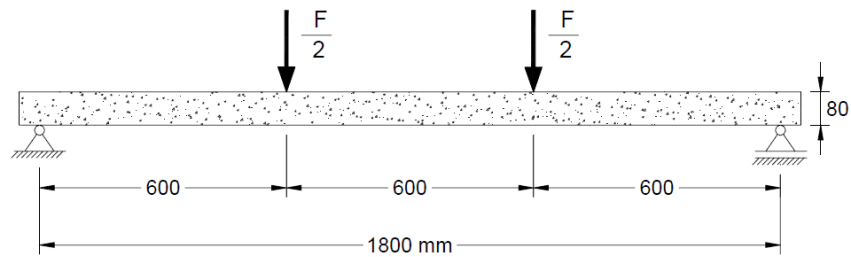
Configuração das lajes ensaiadas por Bonaldo *et al.* (2007) (dimensões em mm).
